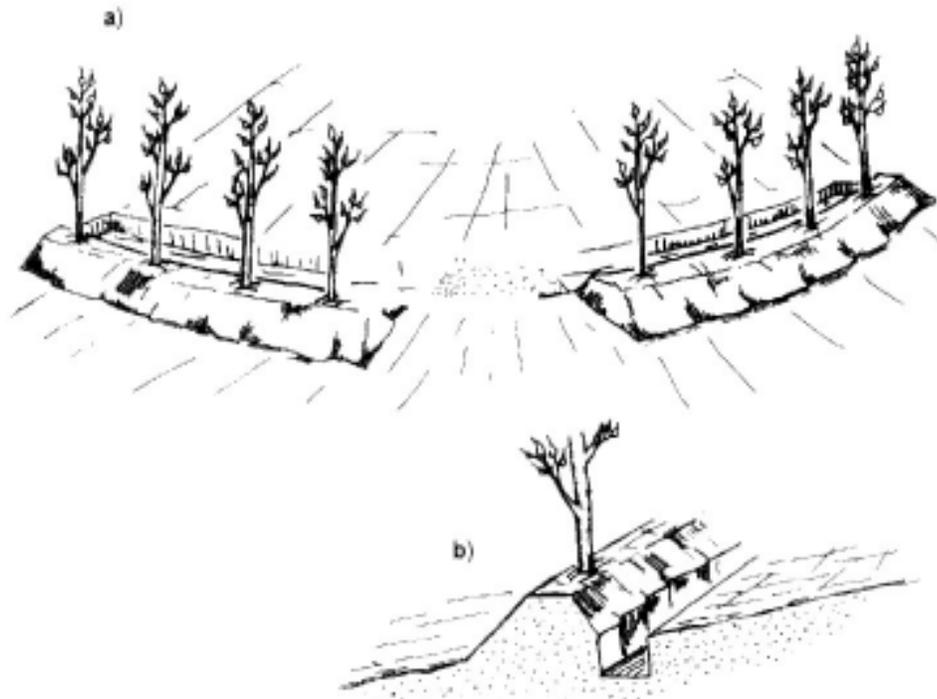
Zanja trinchera: a) vista superior; y b) corte lateral.
